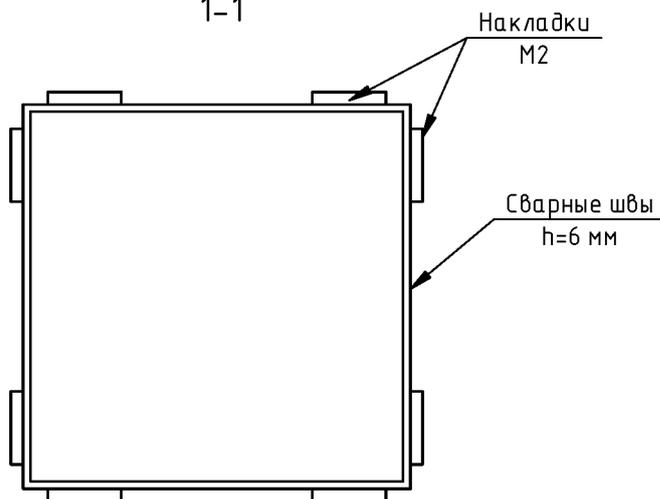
Схема сварки секций свай четвёртого типа армирования
